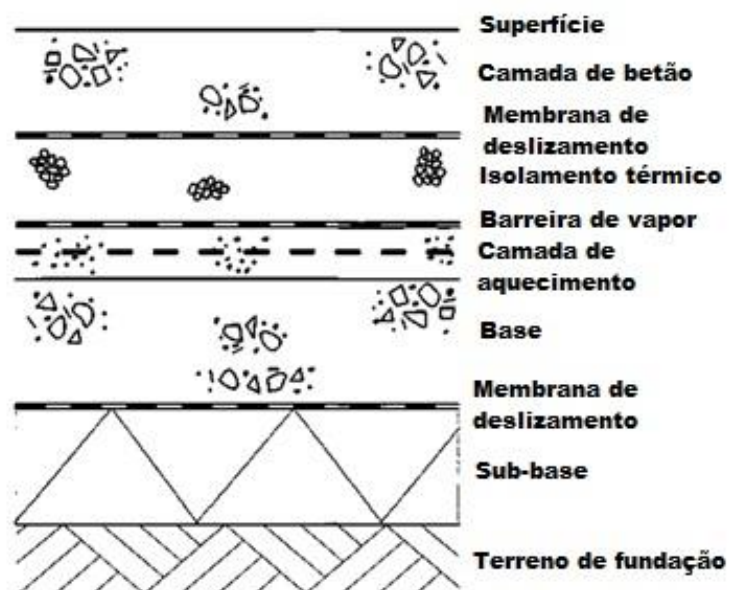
Constituição de pavimento tipo de armazéns frigoríficos [70].
